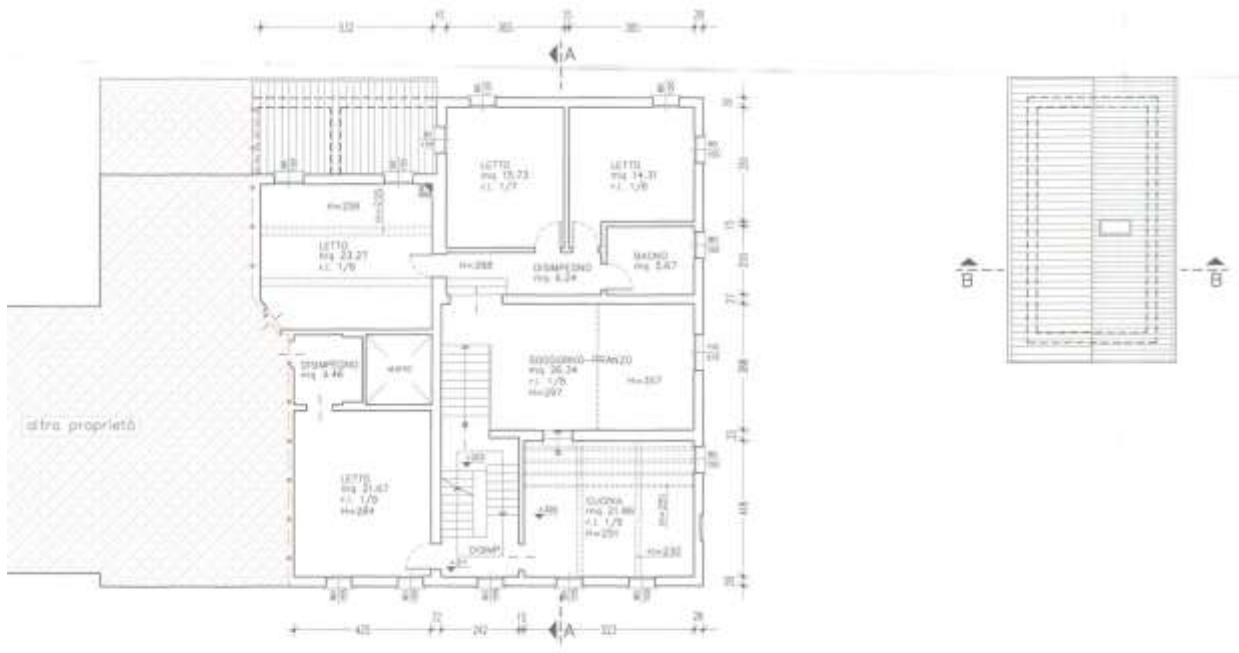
PIANTA PIANO SOTTOTETTO (fuori scala) - Rif. C.I.L. Prot. n. 18111 del 12/11/91
